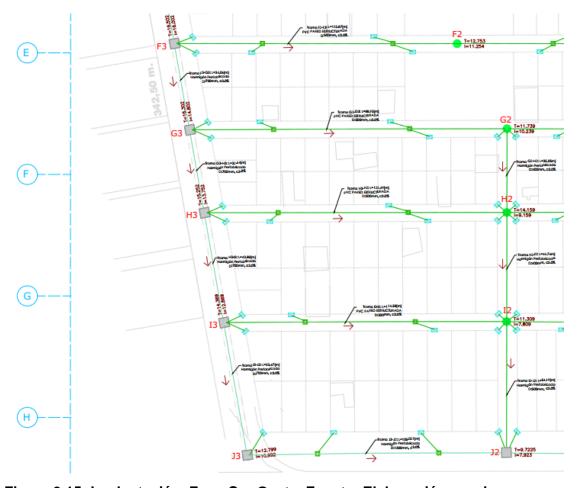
Implantación. Zona Sur Oeste. Fuente: Elaboración propia.
